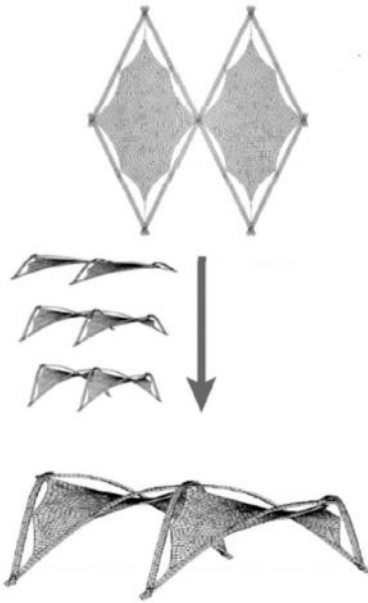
Propuesta de estructura textil híbrida desplegable [9].
